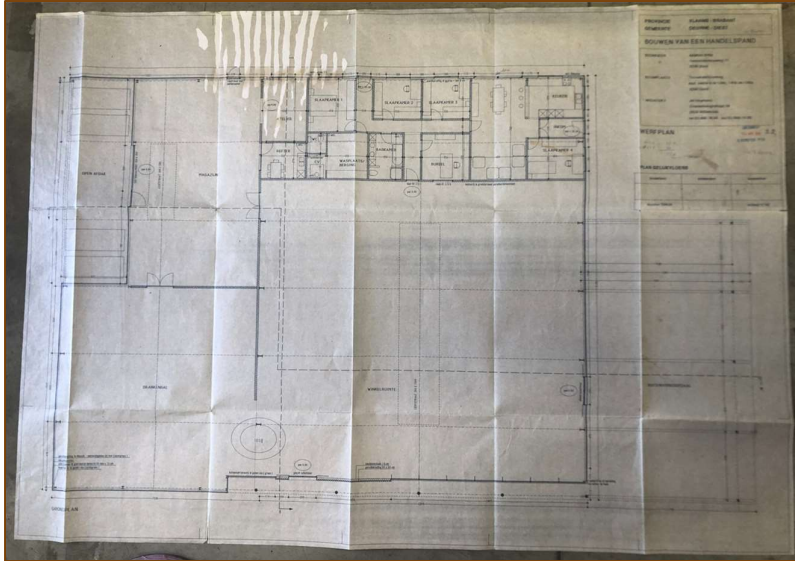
Plattegrond van constructie 1 = het hoofdgebouw (bron: opdrachtgever).
